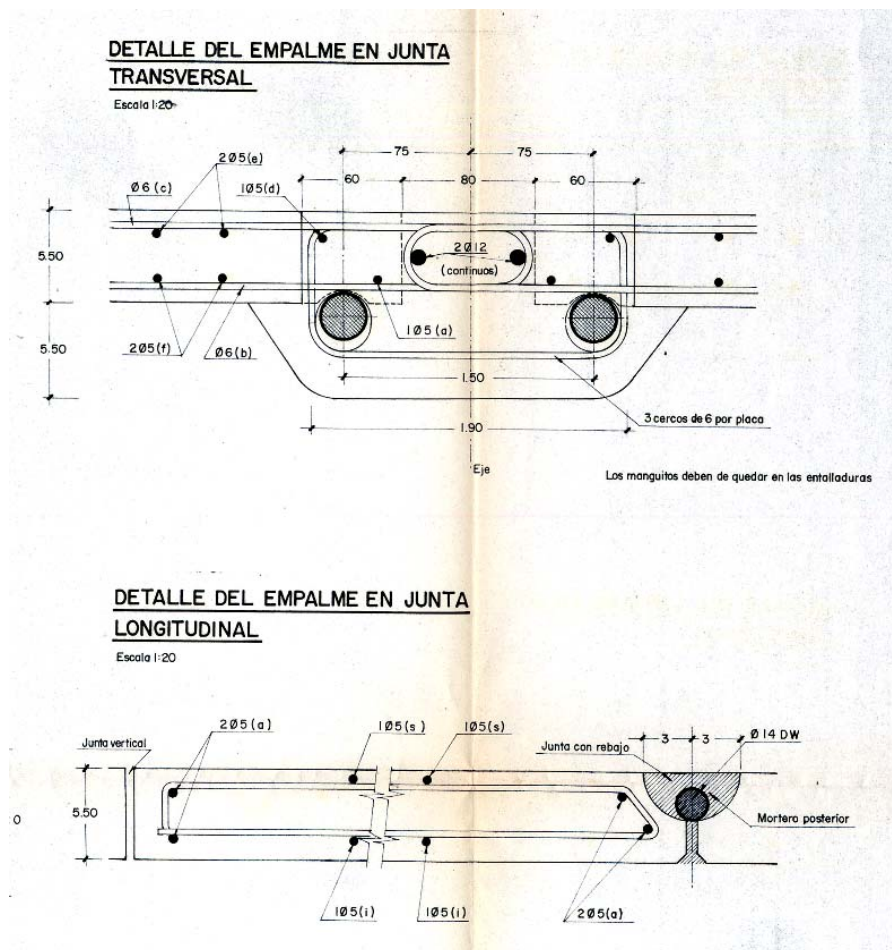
Detalles del proyecto original del las juntas transversal y longitudinal entre placas
